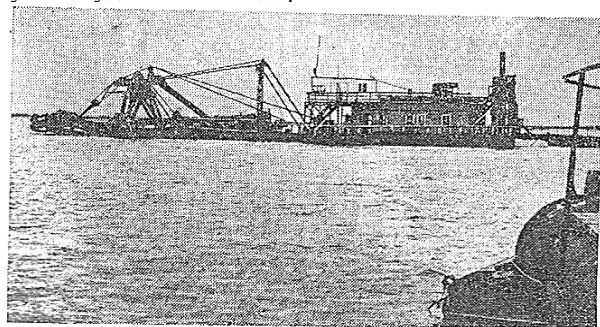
Земснаряд 350-50Л с наружным грунтовым насосом
